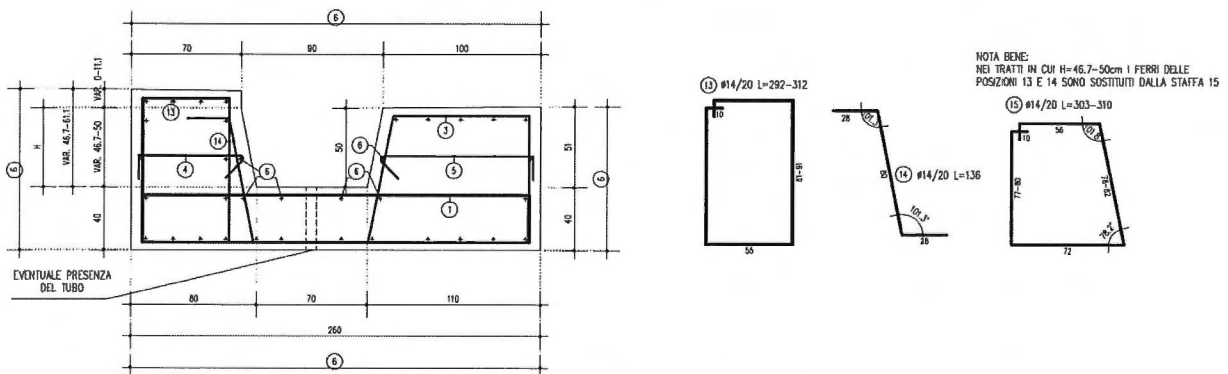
Schema armatura - Sezione Tipo C (Barriera Doppia) – Tratto 3
